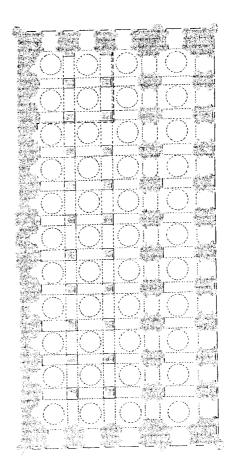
مسقط أفقي لجامع بابا آدم في رامبال بالبنغال . (عن : Michell) .
